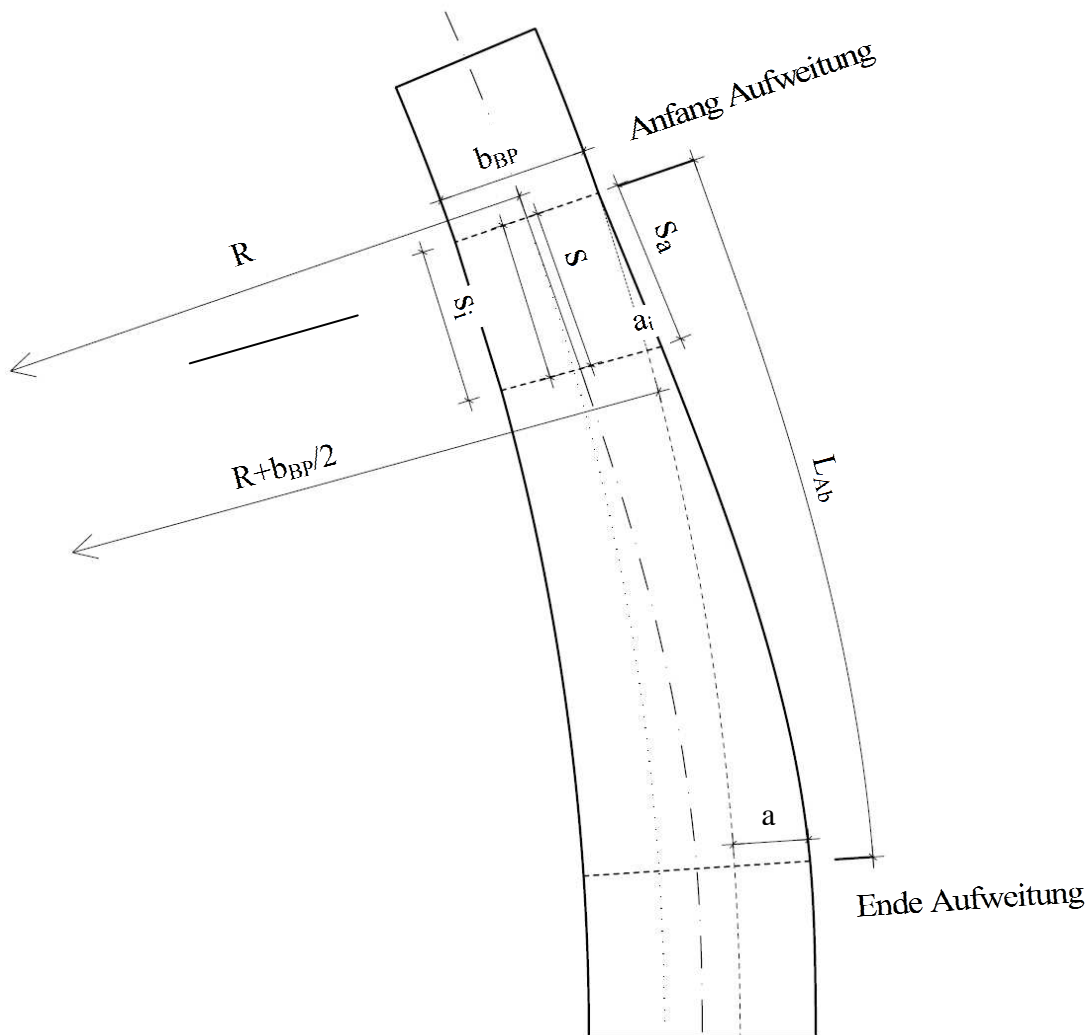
Skizze Berechnung - Grundrisselement Bogen
